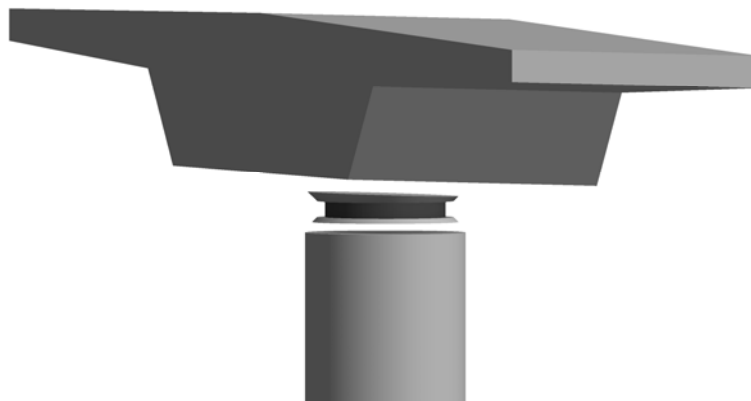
Vista desplazada de tablero, apoyo circular y pila.
